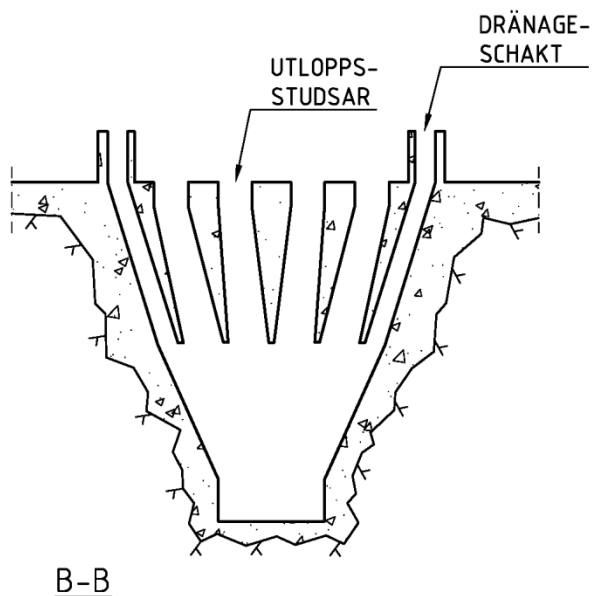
till Figur 5.3 visar utloppsstudsar, dränageschakt och kylvattentunnel för R3.
